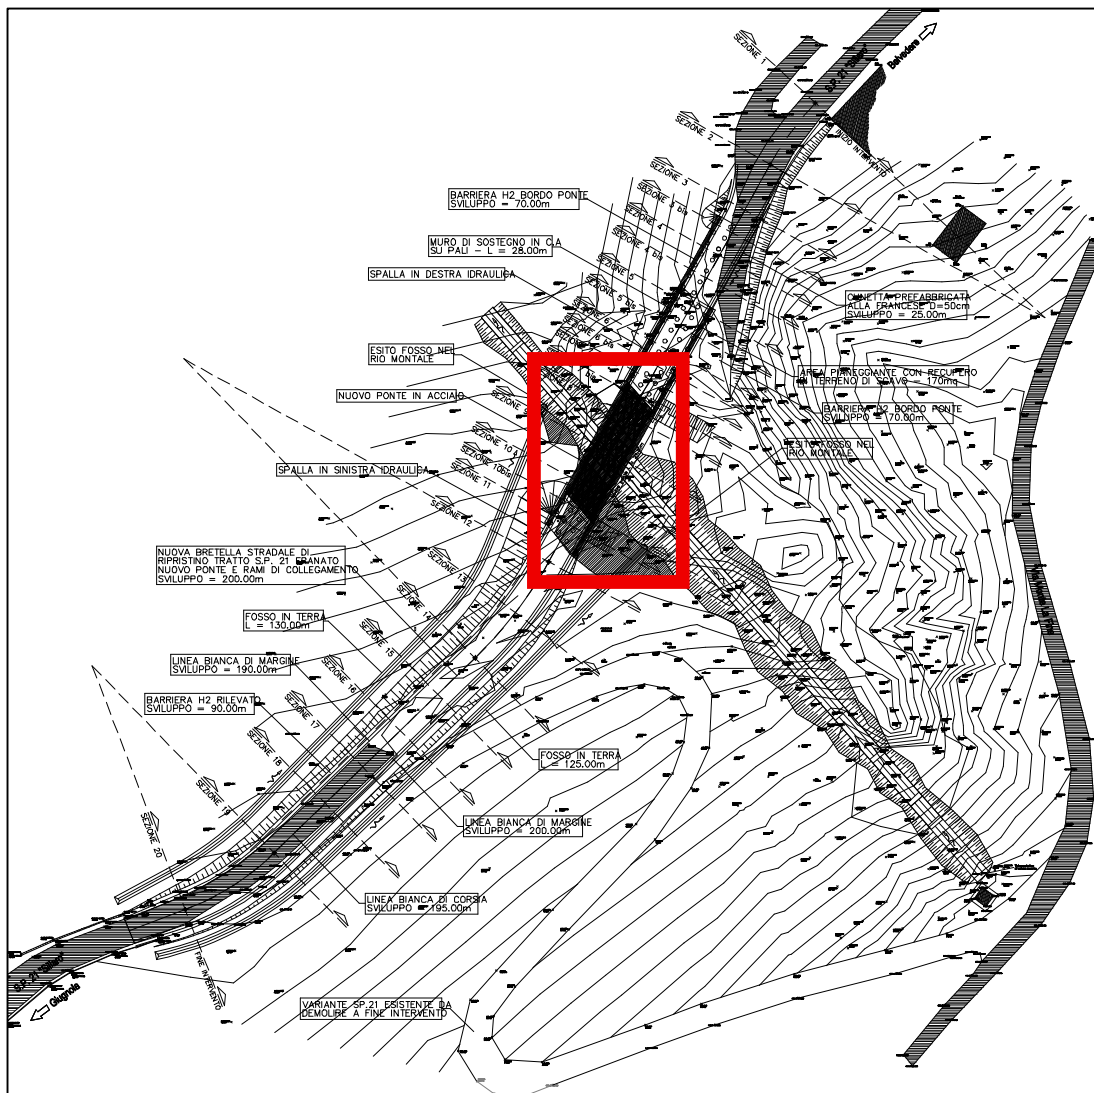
Planimetria con ubicazione della nuova strada con indicato il tratto occupato dal ponte.
